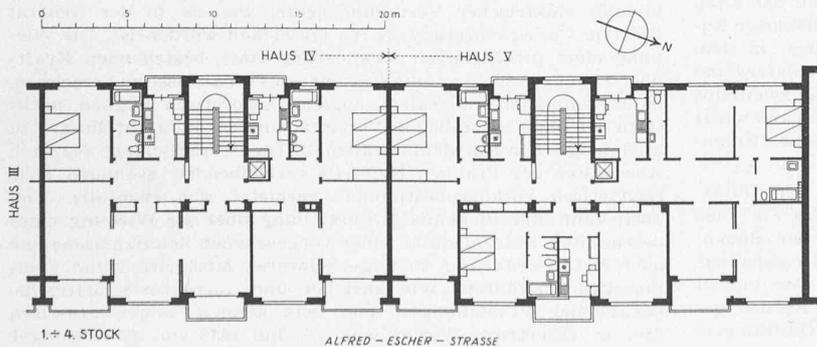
«Venedigli»-Häuser IV und V. Grundriss 1:400
